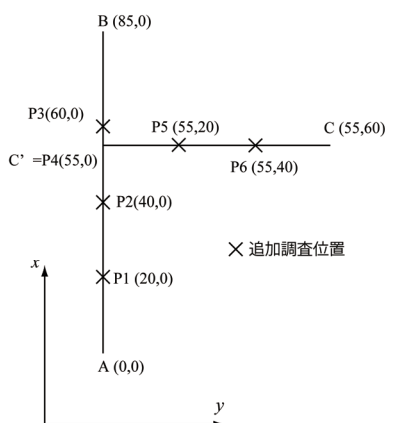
解析対象サイト平面図 既存ボーリング位置(A,B,C)と追加候補調査位置(P1~P6)
